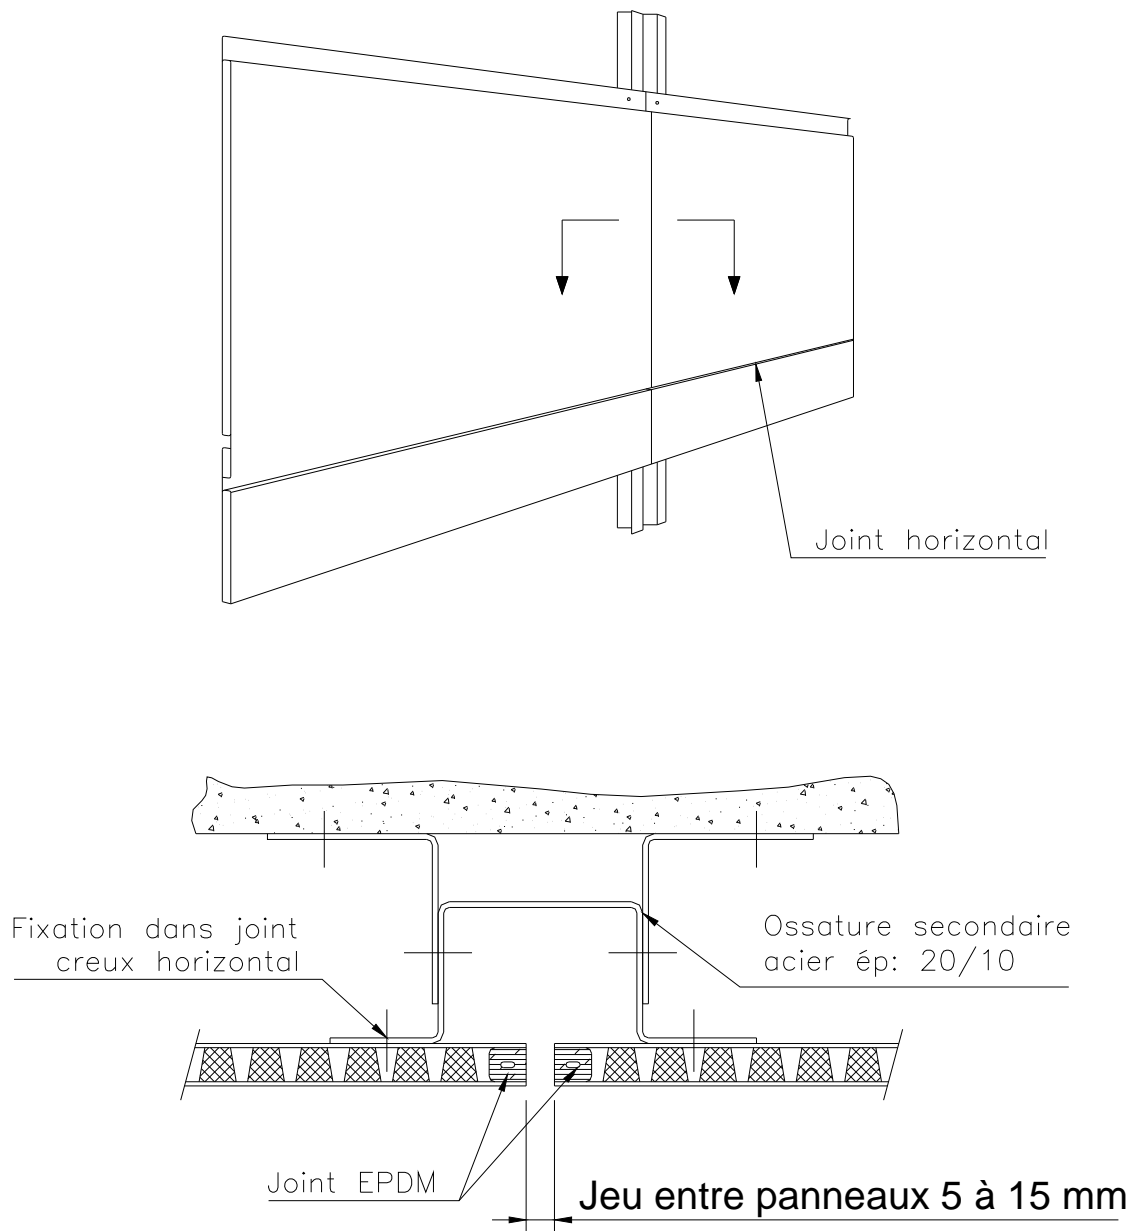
Panneau ISOFRAN à bords profilés -Pose horizontale - Joint vertical
